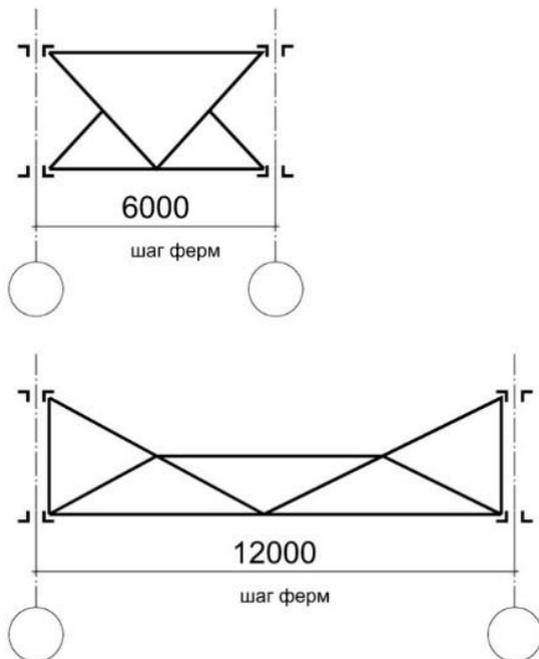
(окончание). Схема связей в покрытии со стальными фермами:
